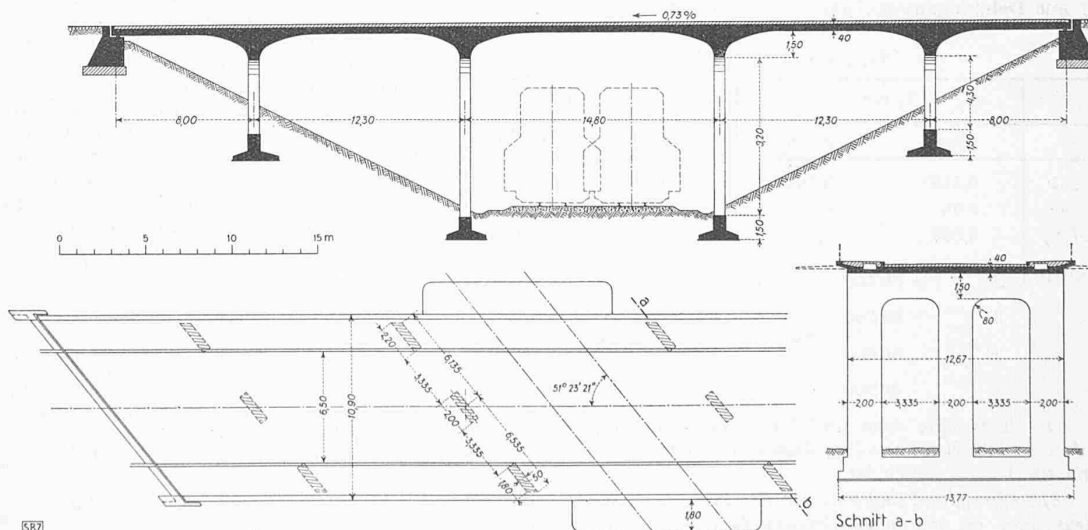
Längsschnitt, Grundriss und Schnitt a-b parallel zur Eisenbahn-Axe. — 1 : 400
